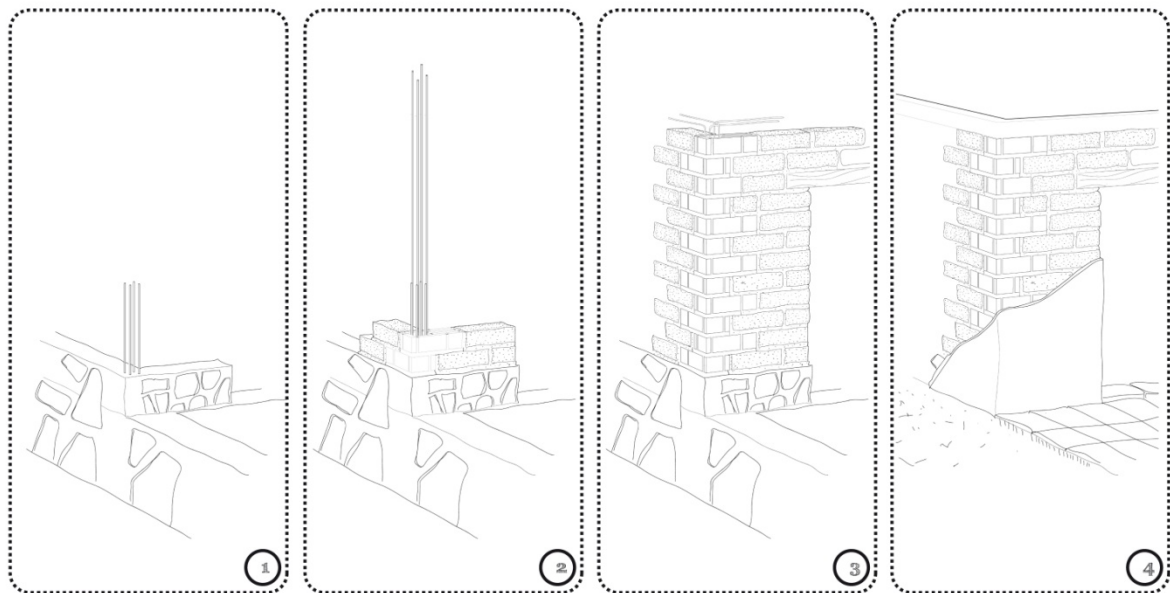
Axonometría del proceso de construcción del detalle en esquina
